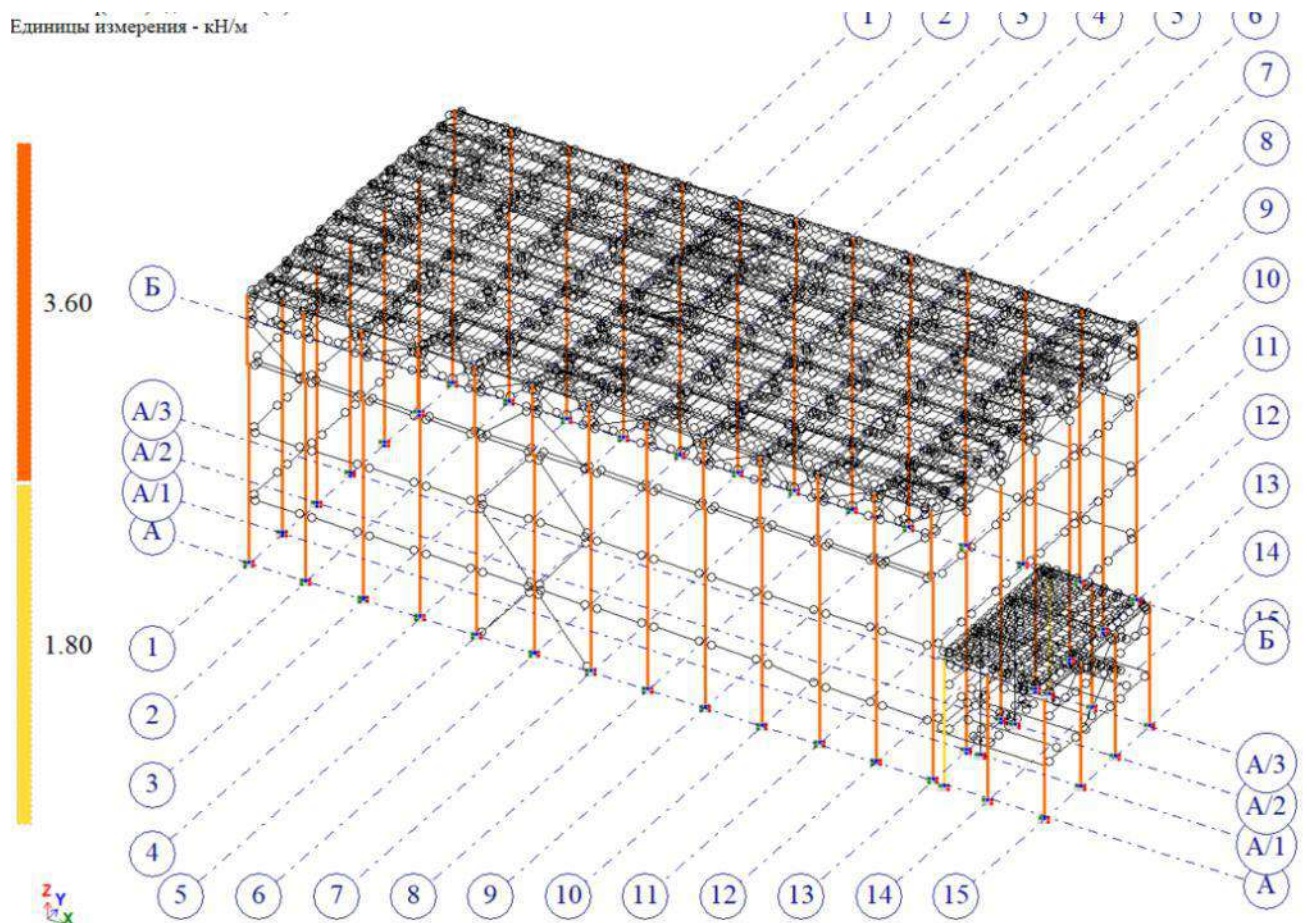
Нагрузка от собственного веса конструкции наружных стен, кН/м
